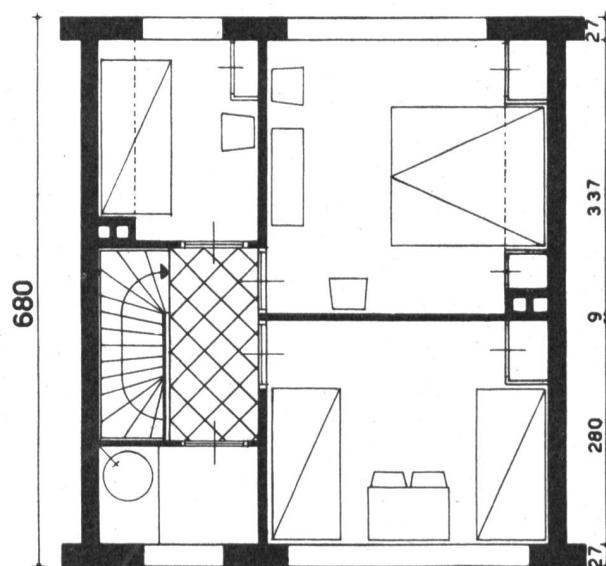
Obergeschoss-Grundriss zu Abb. 4.
